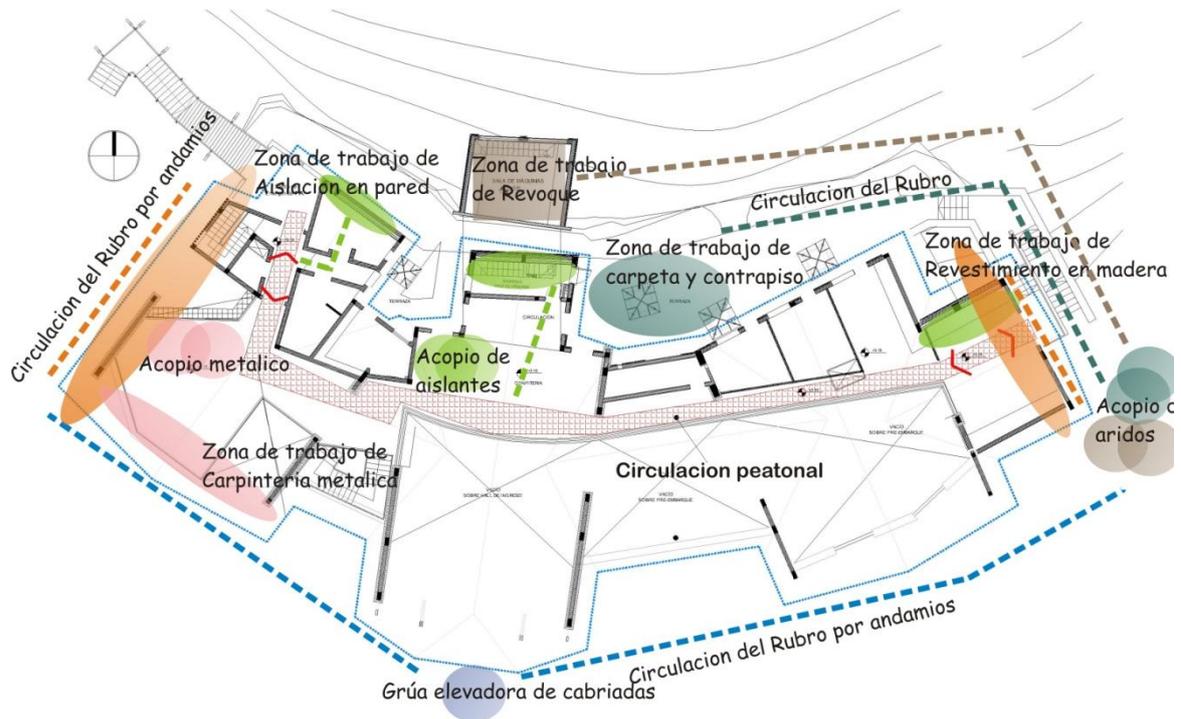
Zonas de trabajo por Rubro en Planta Alta de la Obra.
